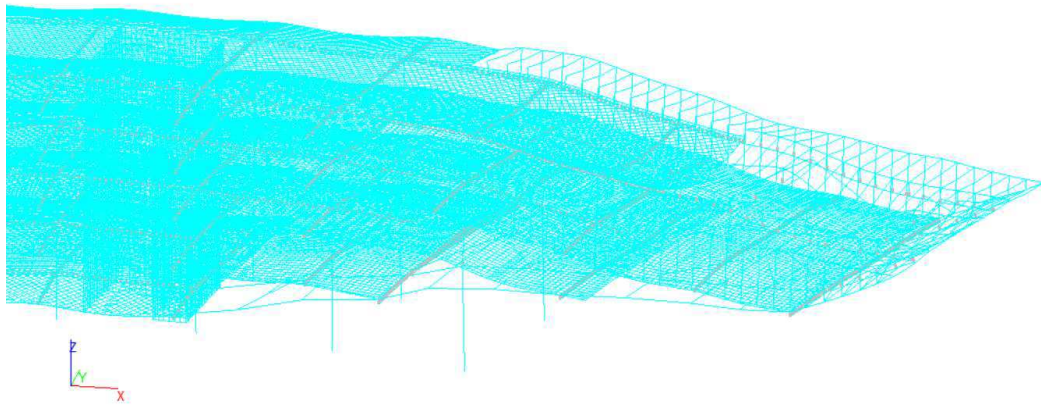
Схема деформирования от комбинации нагрузок с ветровой нагрузкой
